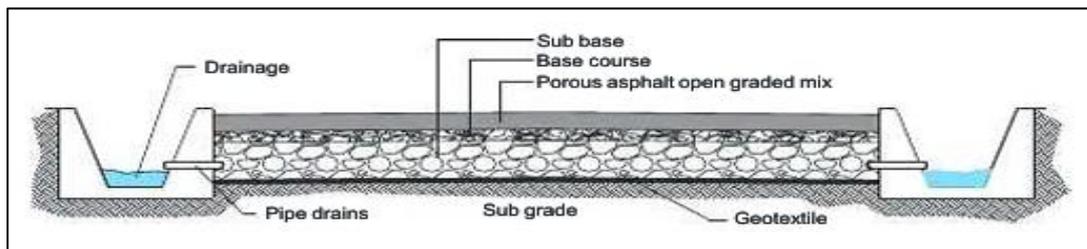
6 Konstruksi Aspal Porous Pada Lapangan Parkir di Hackesin, Delaware
